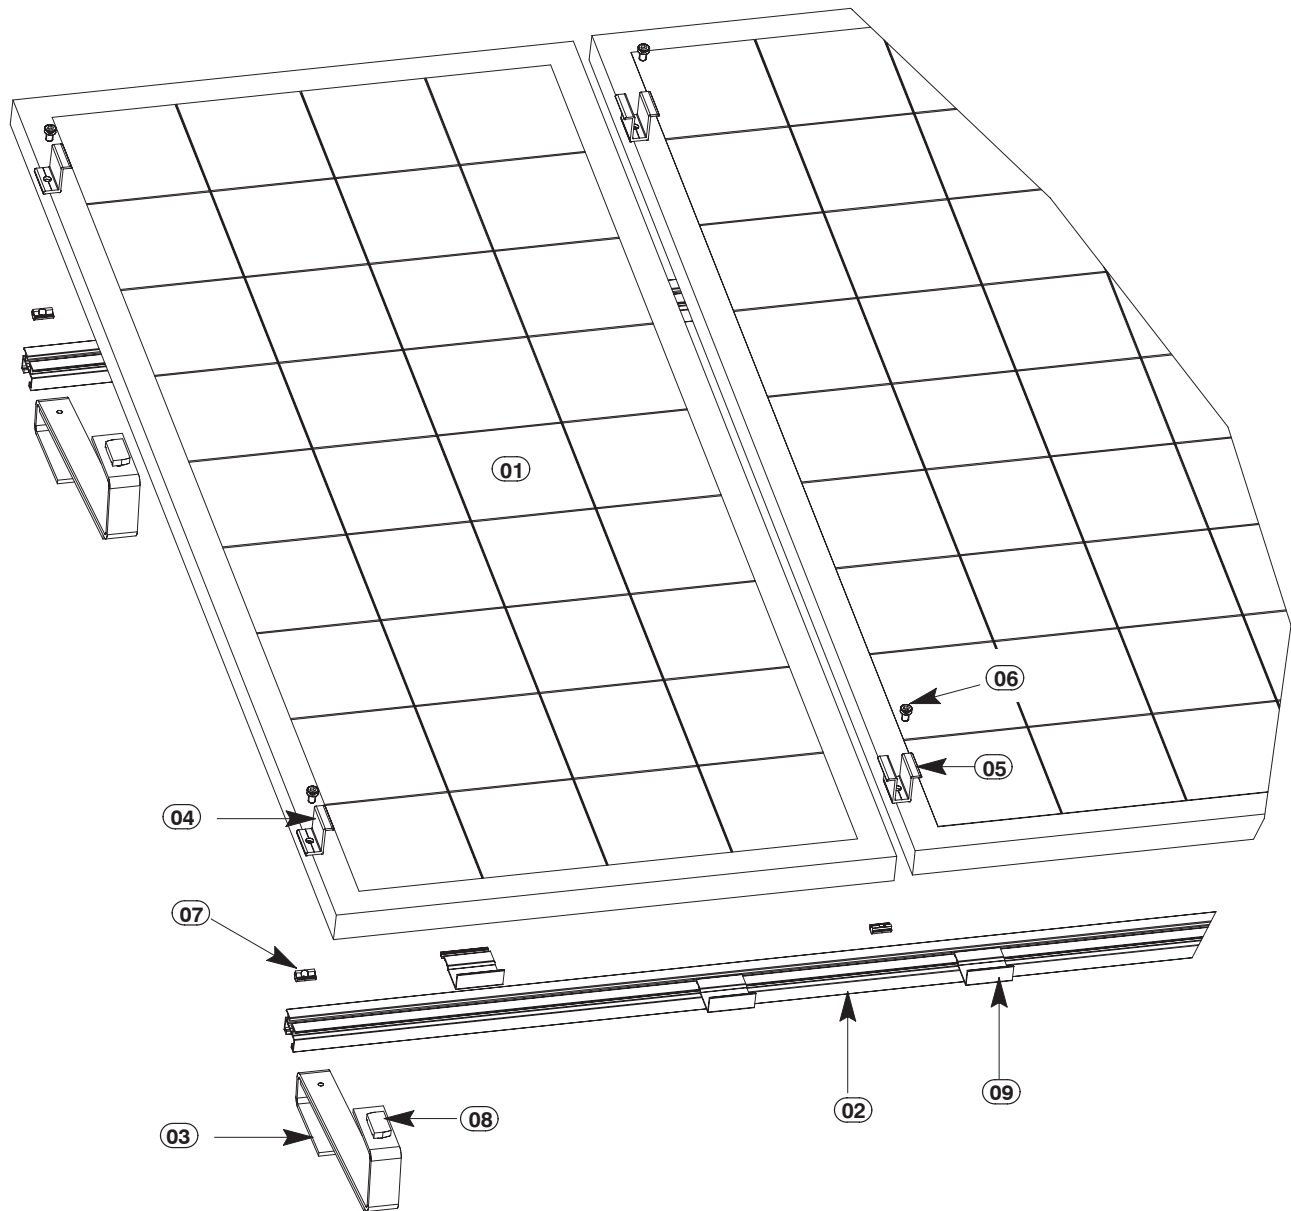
Montage en appui des capteurs PV horizontaux en bande horizontale, système PV-Light
